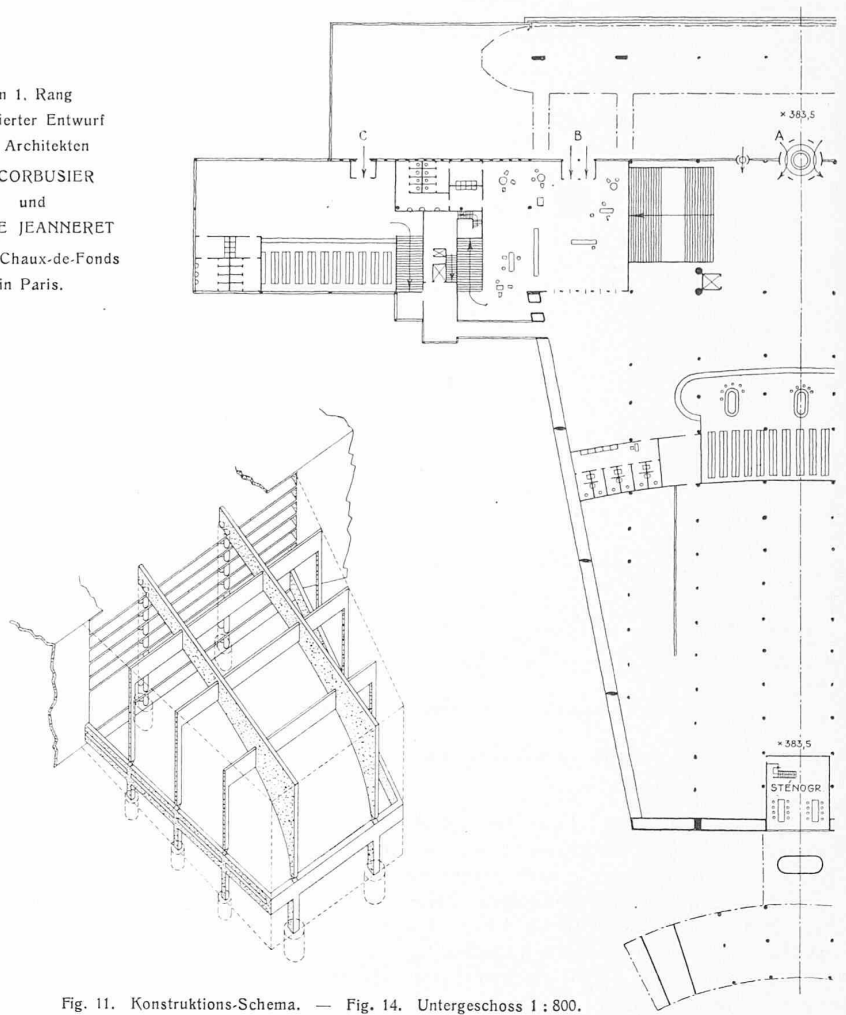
Konstruktions-Schema. — Fig. 14. Untergeschoss 1 : 800.
